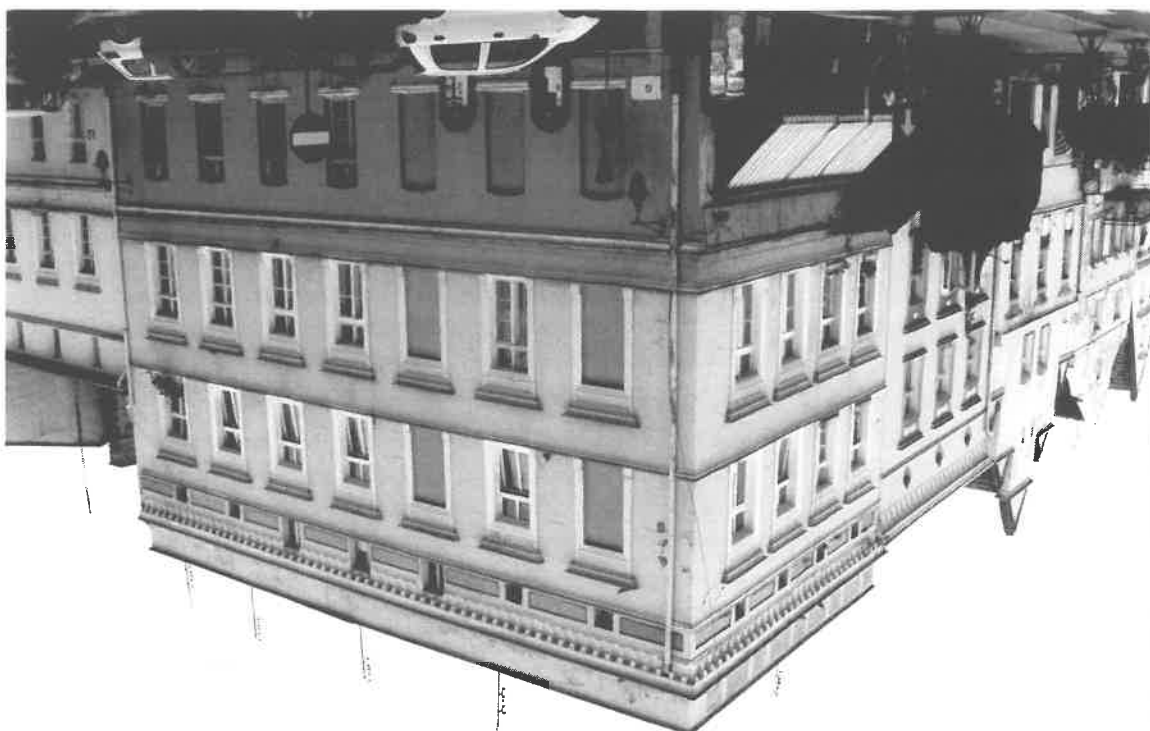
/10. Kamienica Rynek 1, elewacja południowa (widok od południowego-
